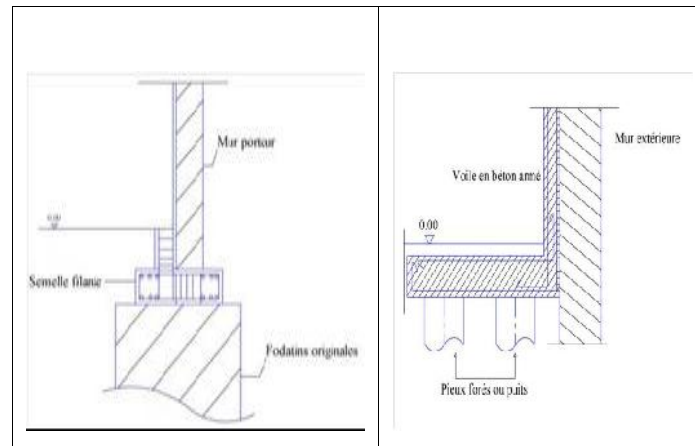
Confortation des fondations et renforcement des murs par des voiles en BA [11]
